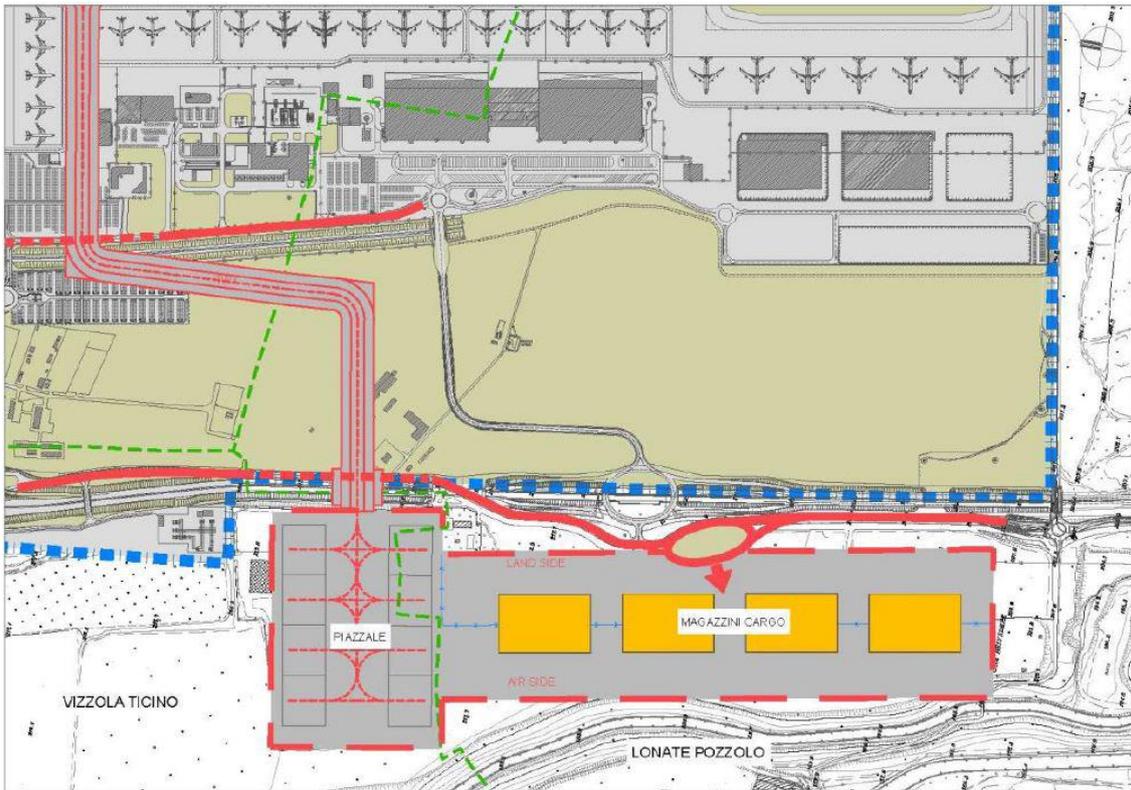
Ipotesi 2 (alternativa 8) schema di lay out fonte: Masterplan 2035
